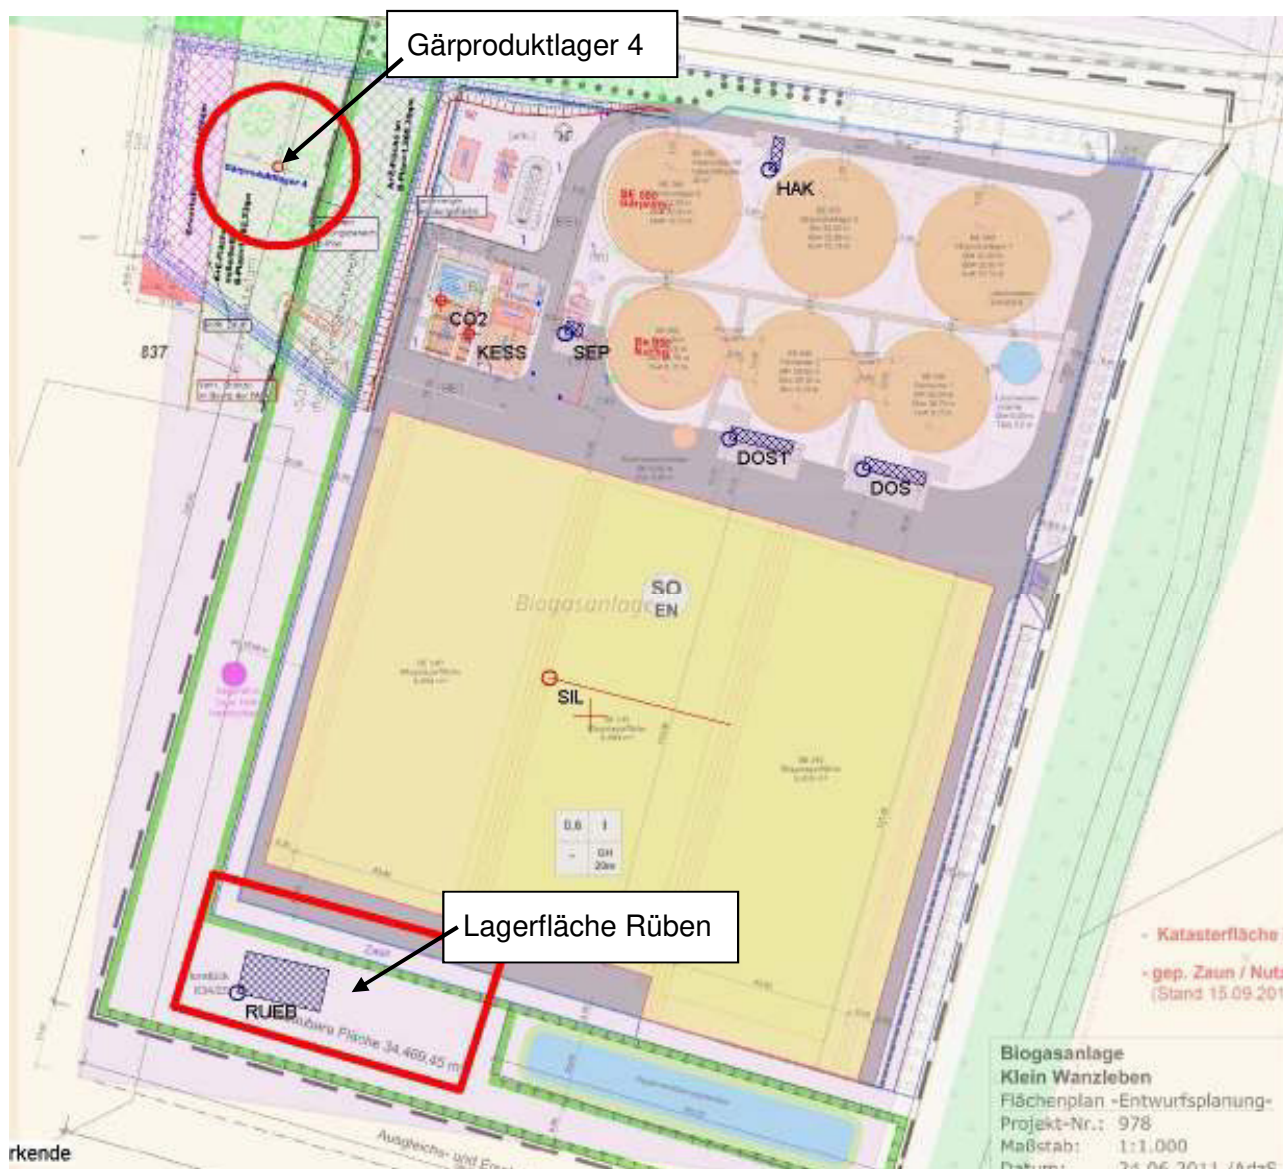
Lageplan der Anlage, Planungsstand April 2018
